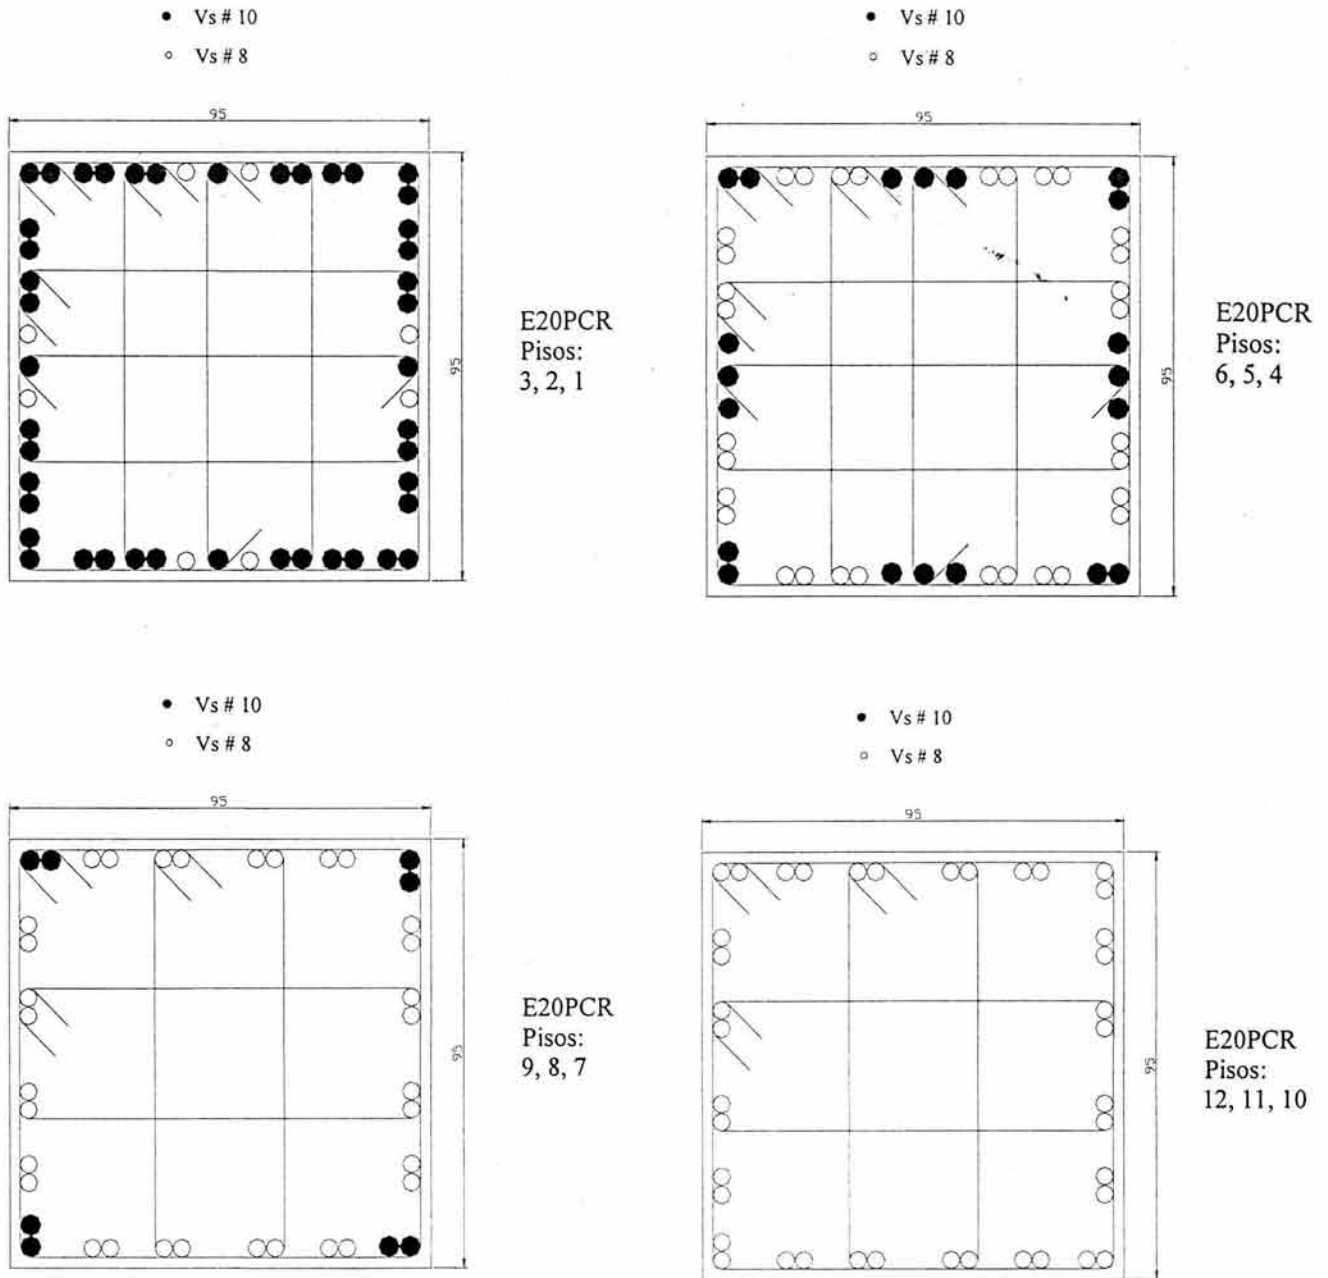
Detallado de columnas en edificio de 20 niveles, marcos interiores.
